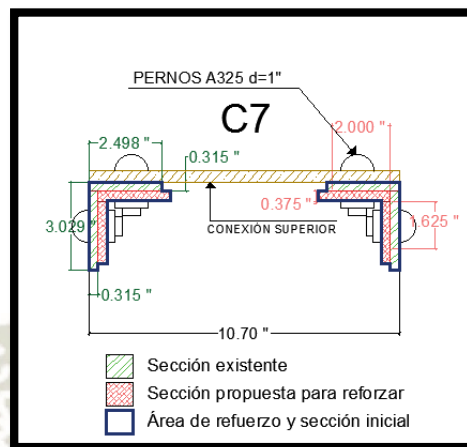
Sección de perfil real más perfil de reforzamiento de C7 – Compuesta. Arriostre
